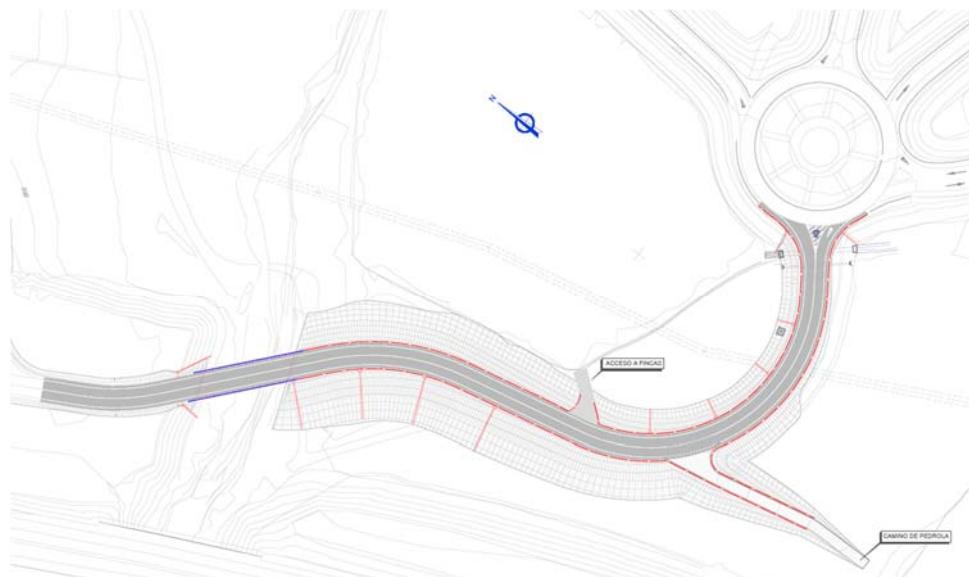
Imagen del plano 4.1 del Proyecto (Planta Proyectada)
